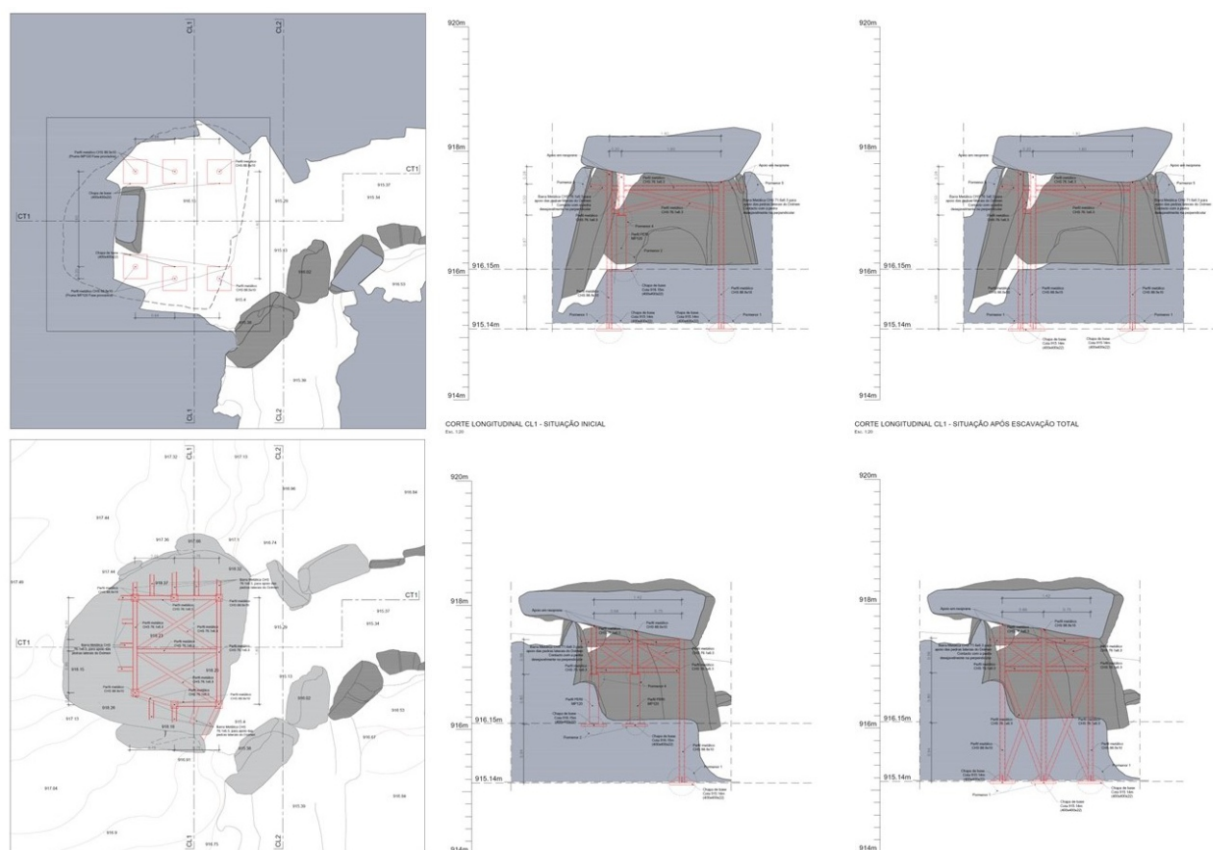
Projeto de estabilidade elaborado para a câmara funerária da Lapa da Meruje: plantas e cortes longitudinais e transversais da 1.ª fase (coluna do meio) e 2.ª fase (coluna na direita) de colocação da estrutura metálica de apoio (estudo e peças gráficas por A. Costa)
